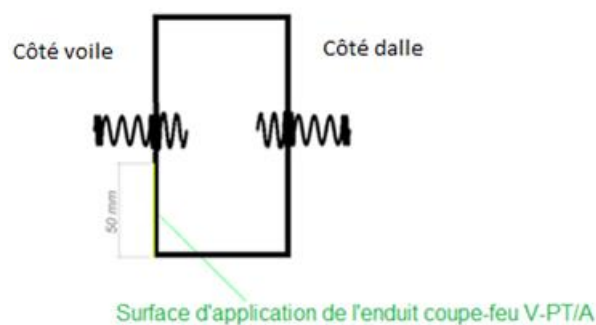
Mise en œuvre de l'enduit coupe-feu V-PT/A (Coupe au droit de la bande isolante)
